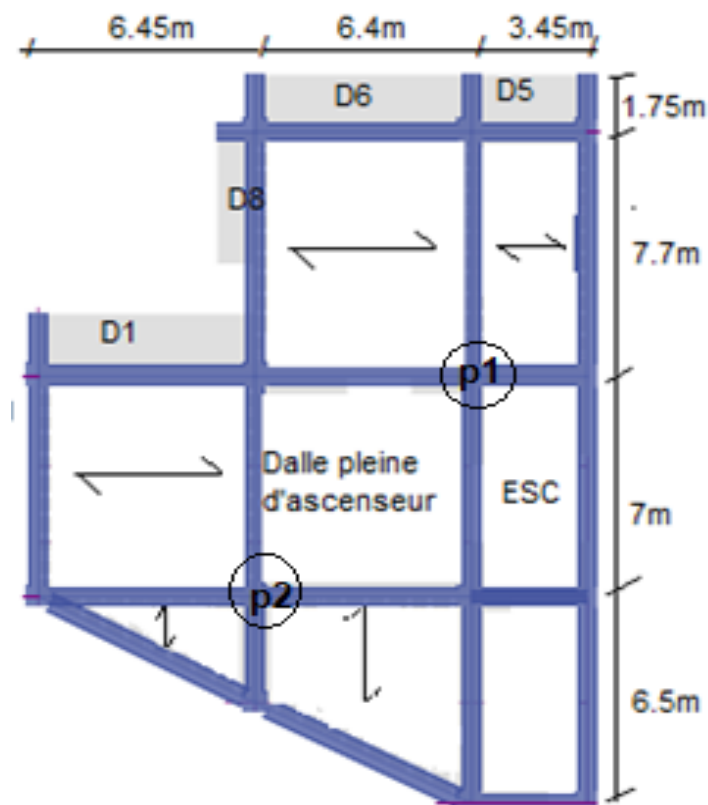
Plan de disposition des poutrelles (RDC et service)
